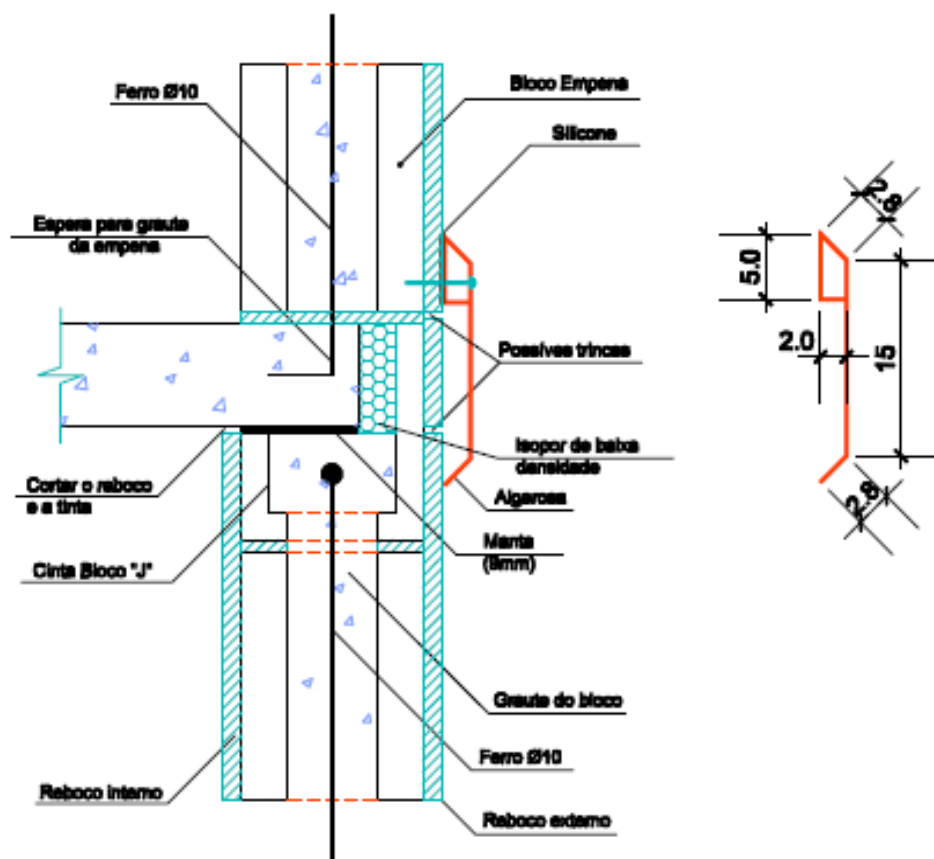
detalhe do apoio da última laje com empenas utilizando blocos J
